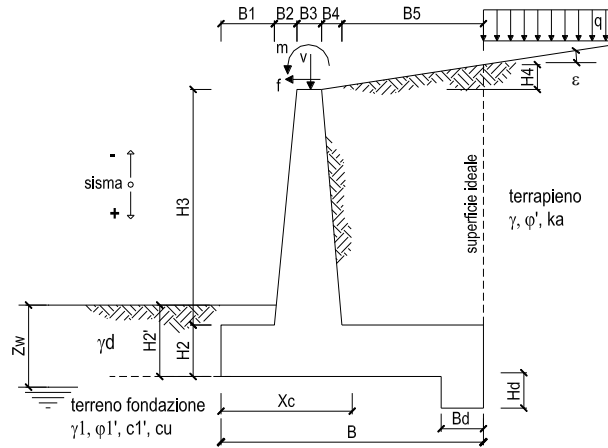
Caratteristiche geometriche muri di sostegno con fondazione diretta – tipo 1.
